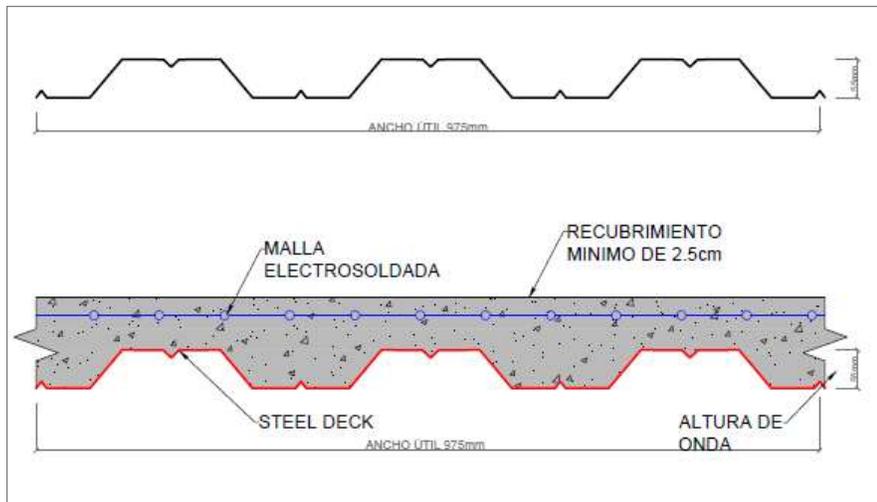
Detalle de Losa con Steel Deck (Fuente: Autor)
